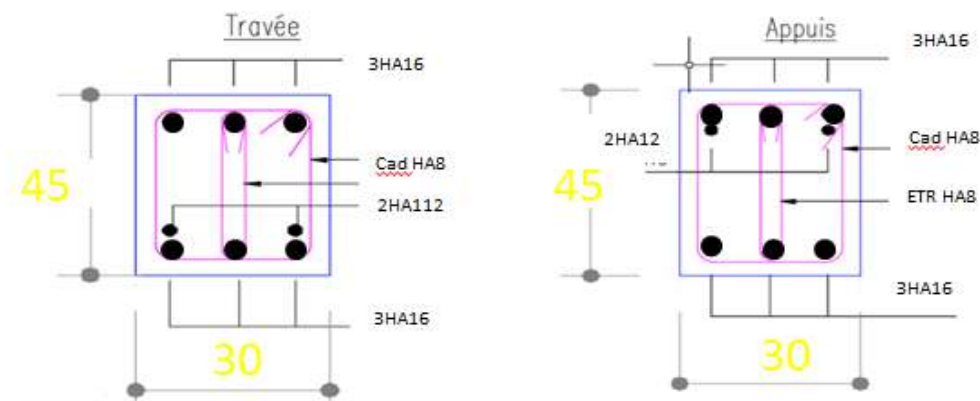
schéma de ferrailage des poutres secondaires en
